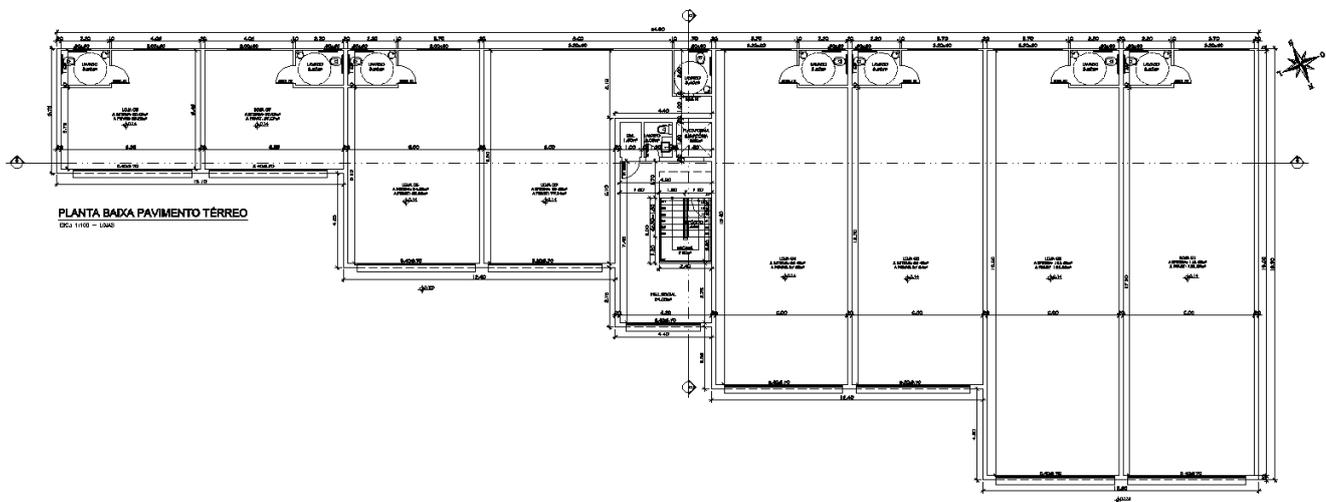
Planta Baixa Pavimento Térreo - Lojas
